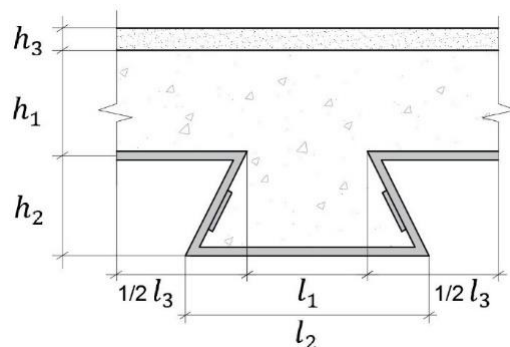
Laje mista aço-betão com revestimento – reentrante.
